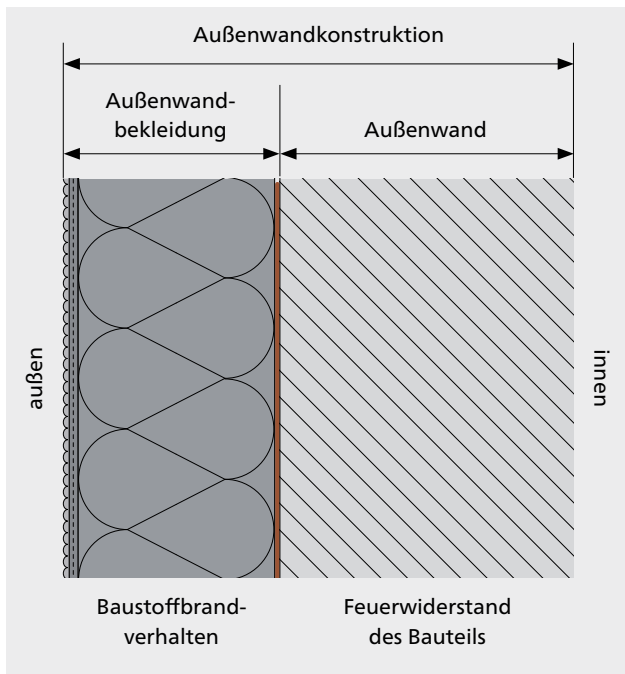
Aufbau einer Außenwandkonstruktion und Brandschutzanforderungen
